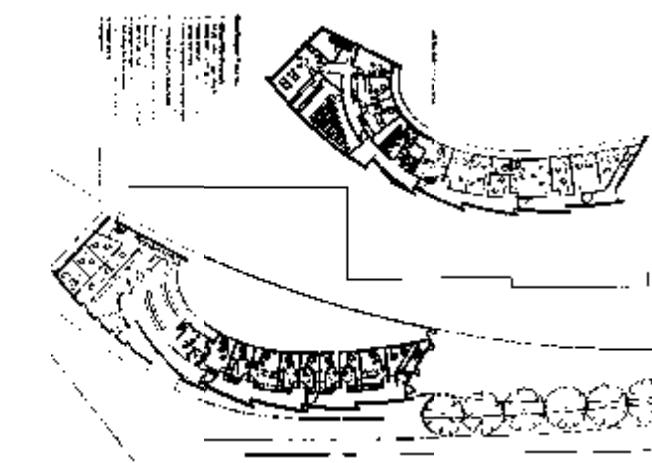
Plantas Arq., Architectural Design New Health Facilities, Barcelona España, Editorial Team, 2001, p. 19
